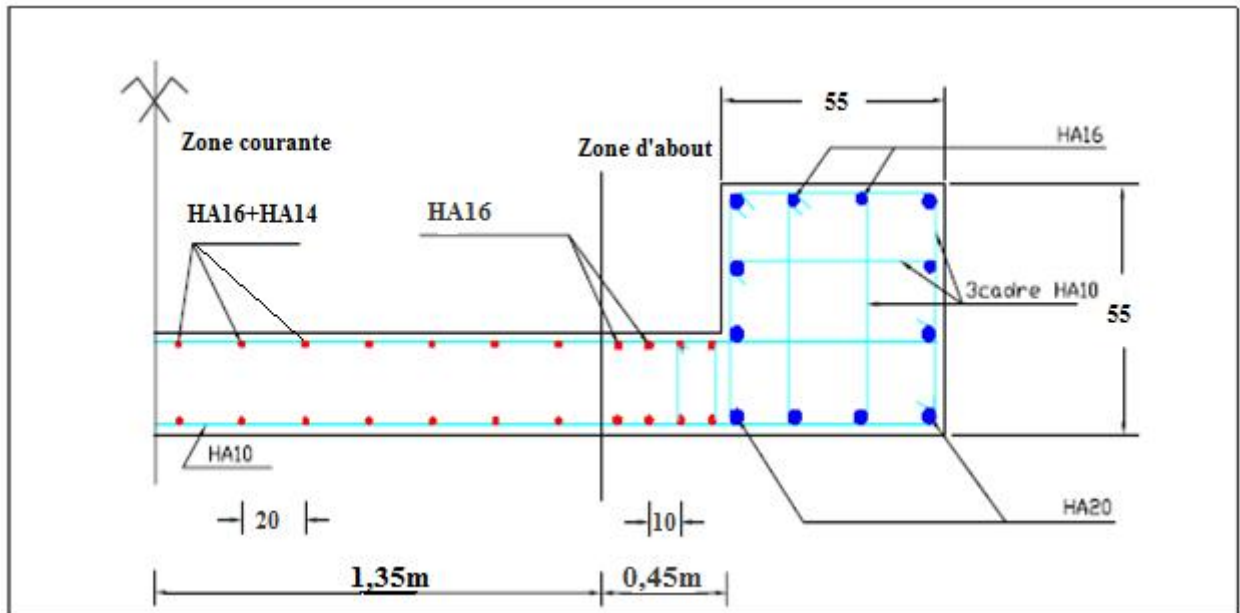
Schéma de ferrailage longitudinal de l'ensemble Poteau (RDC) de rive et de voile V1.
